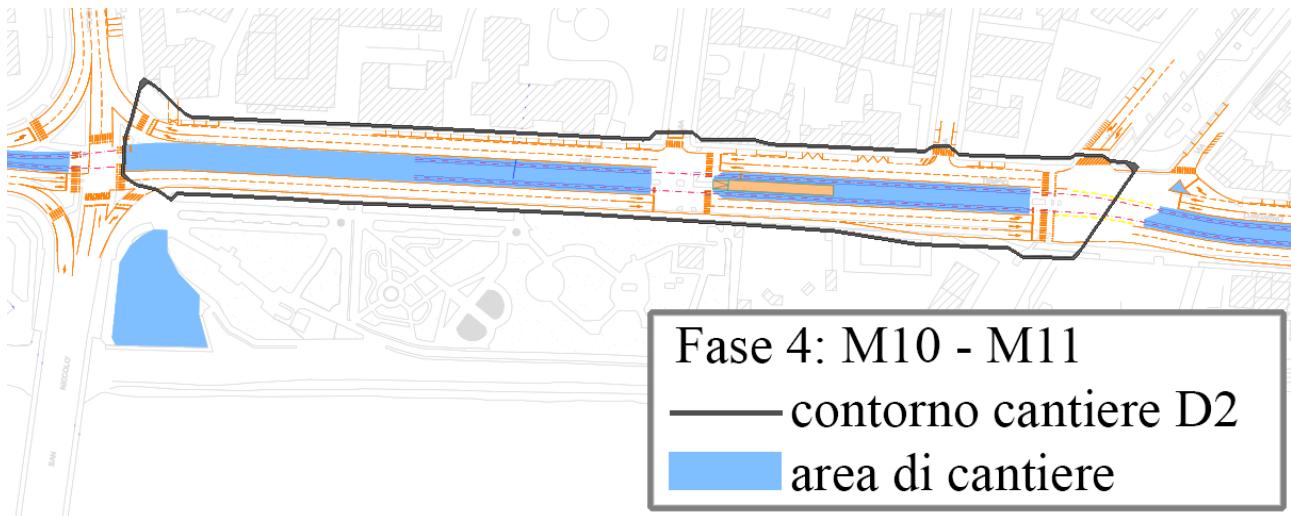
Fase 4 del cantiere D2 - viabilità ai lati dell'area di cantiere con due corsie per senso di marcia - cantiere centrale ristretto al solo ingombro della sede tramviaria
